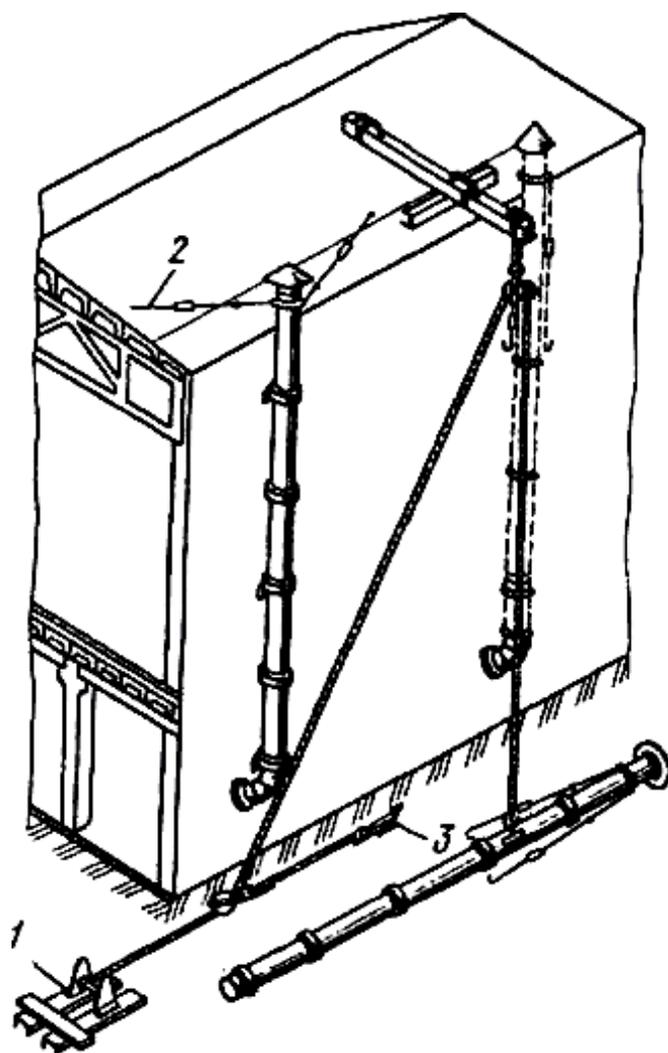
Монтаж наружных вертикальных стальных воздуховодов:
